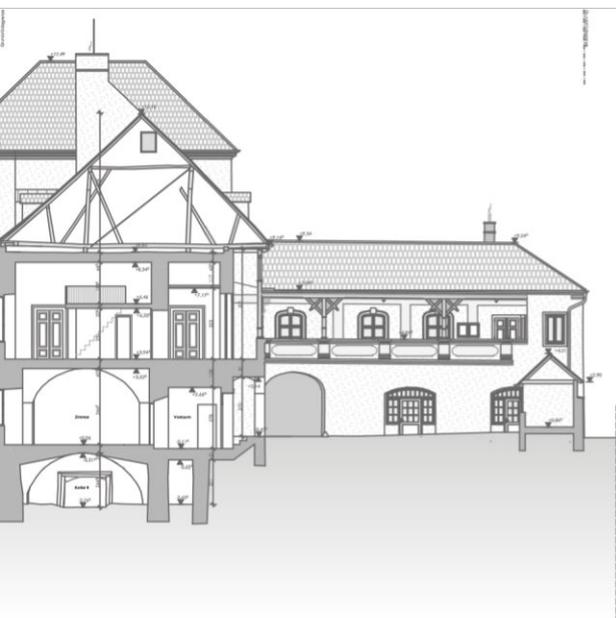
Bestandsplan Schnitt 2-2 Übersichtsplan
